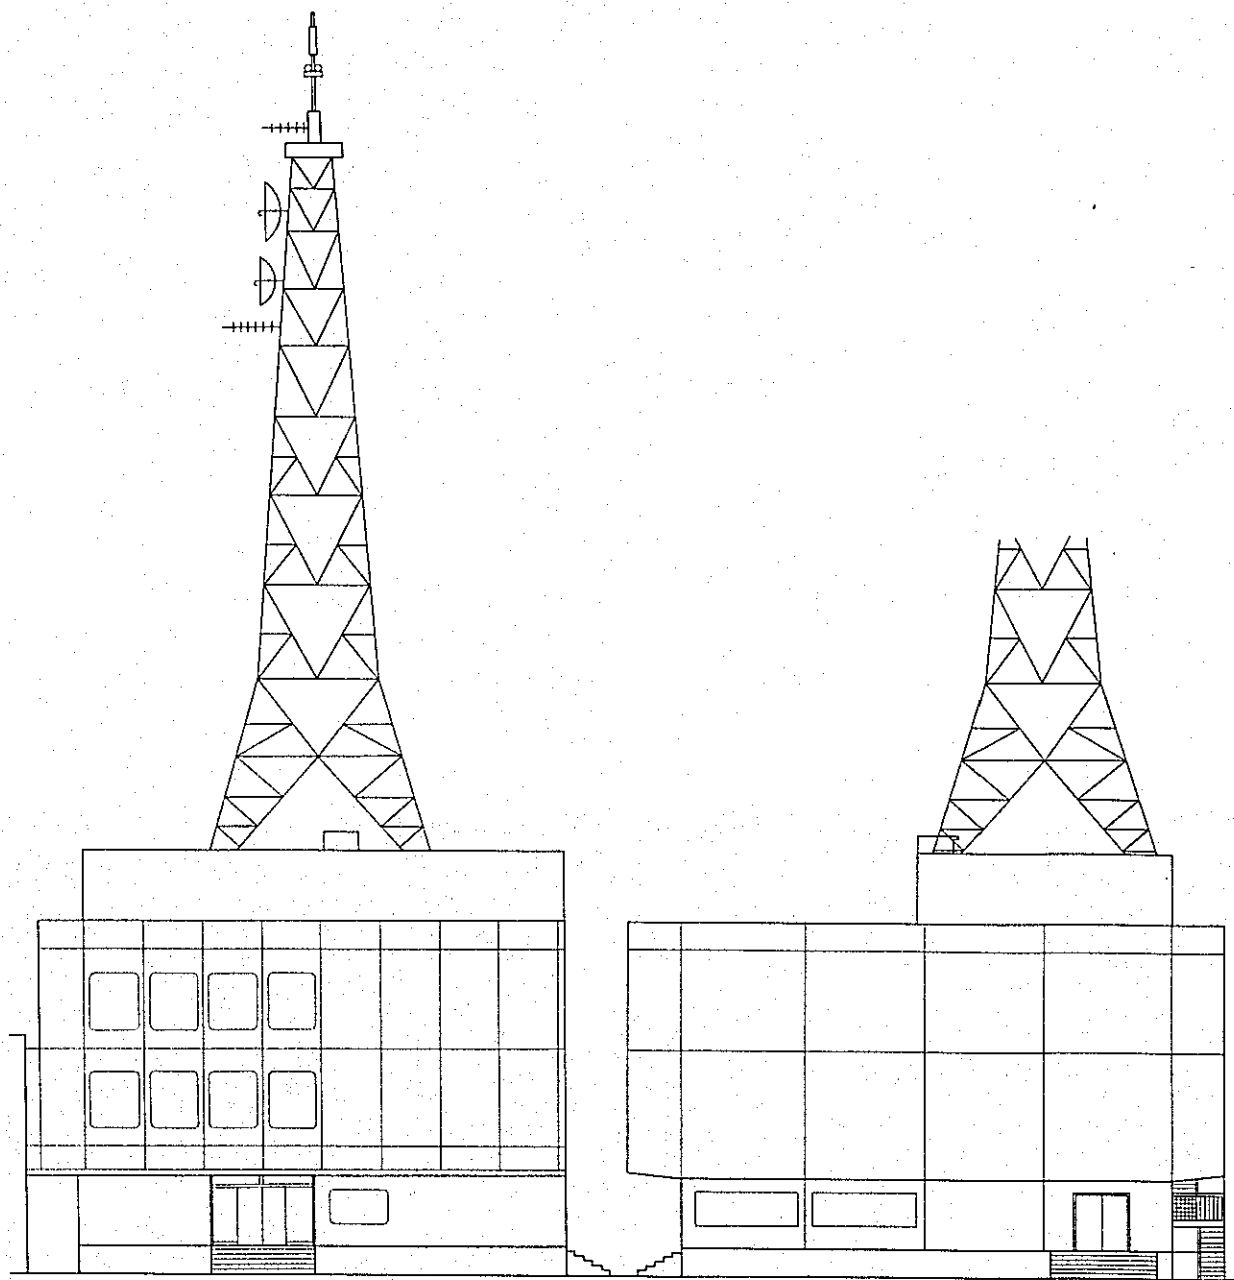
ELEVATION D'UN NOUVEAU BATIMENT DU STUDIO DE RADIO
